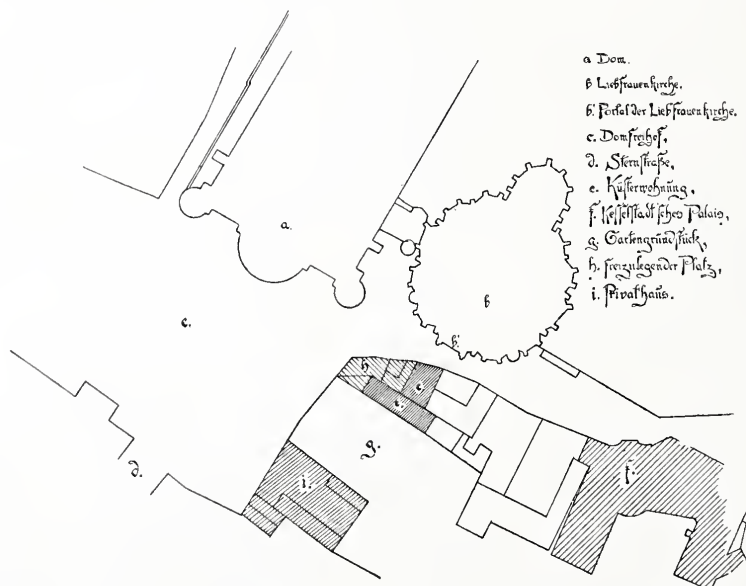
Grundriss der Umgebung der Liebfrauenkirche zu Trier.
